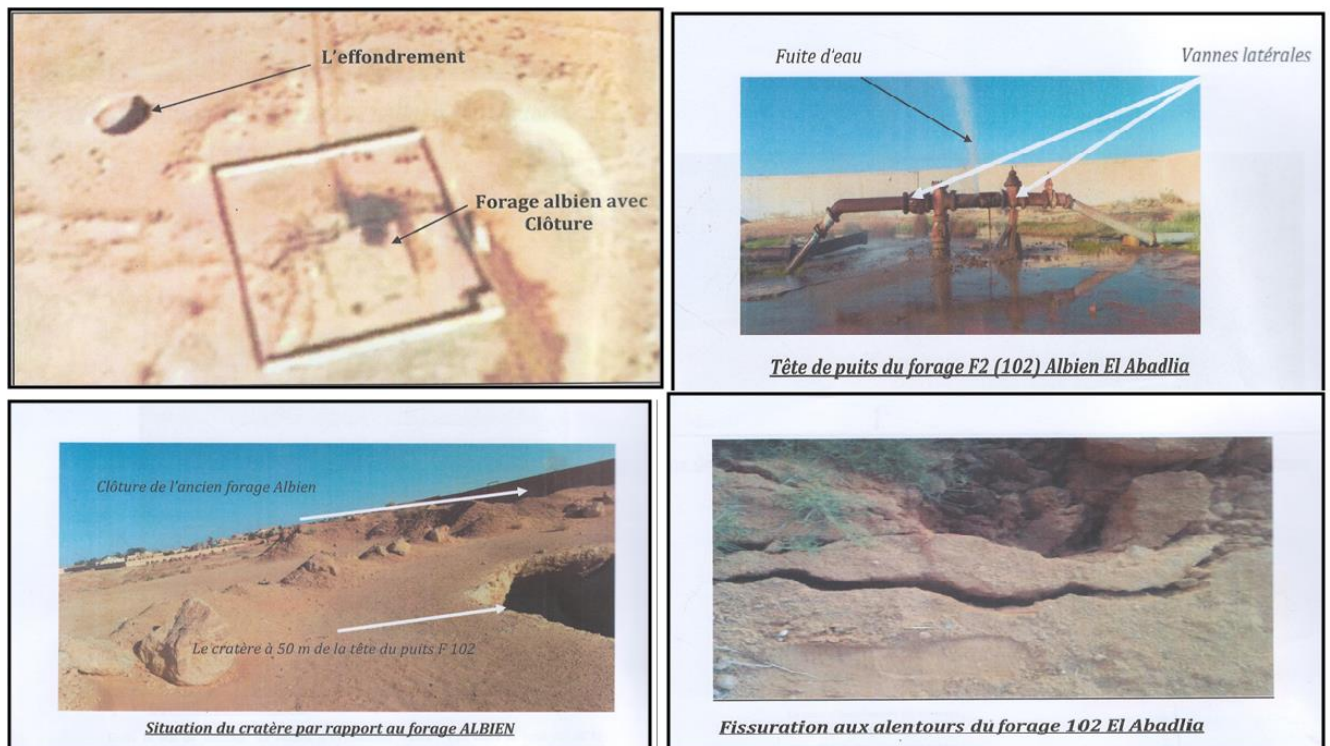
Photos illustrant l'effondrement et la fissuration du terrain à proximité du forage Albien 102.
